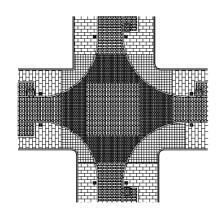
EJEMPLO DE COMBINACIÓN DE PAVIMENTOS EN ENTROQUE TIPO (Fuente: Ayto. de Madrid, Obras de urbanismo e Infraestructuras del barrio de Maravillas y elaboración propia)
